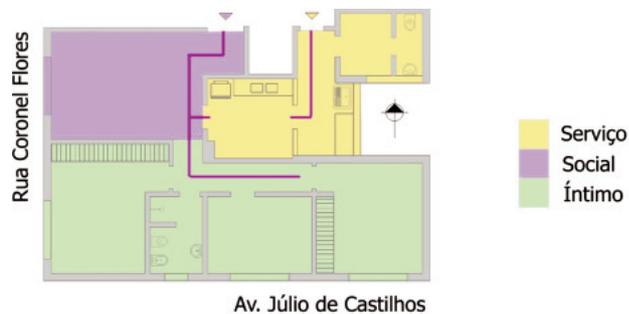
Planta Baixa do Ed. Avenida indicando os acessos
